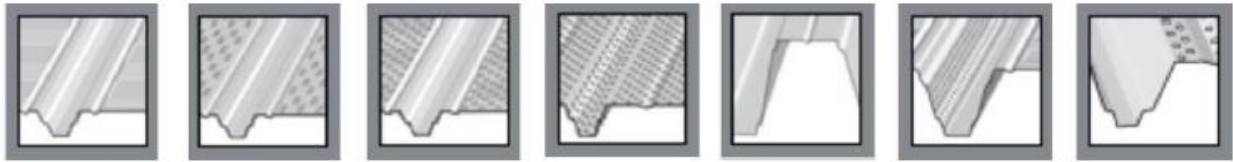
Sistema de losa compuesta con lámina colaborante.
